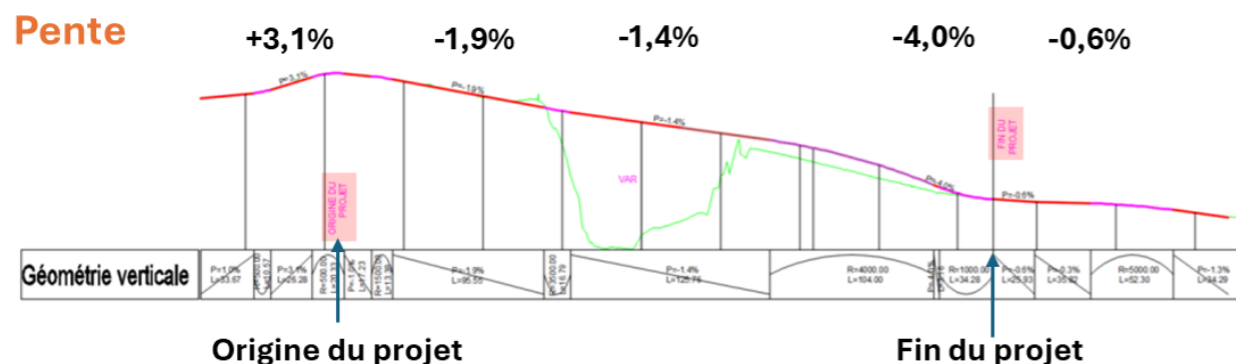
Profil en long de la RD6202 au droit du futur ouvrage de la Trinité
